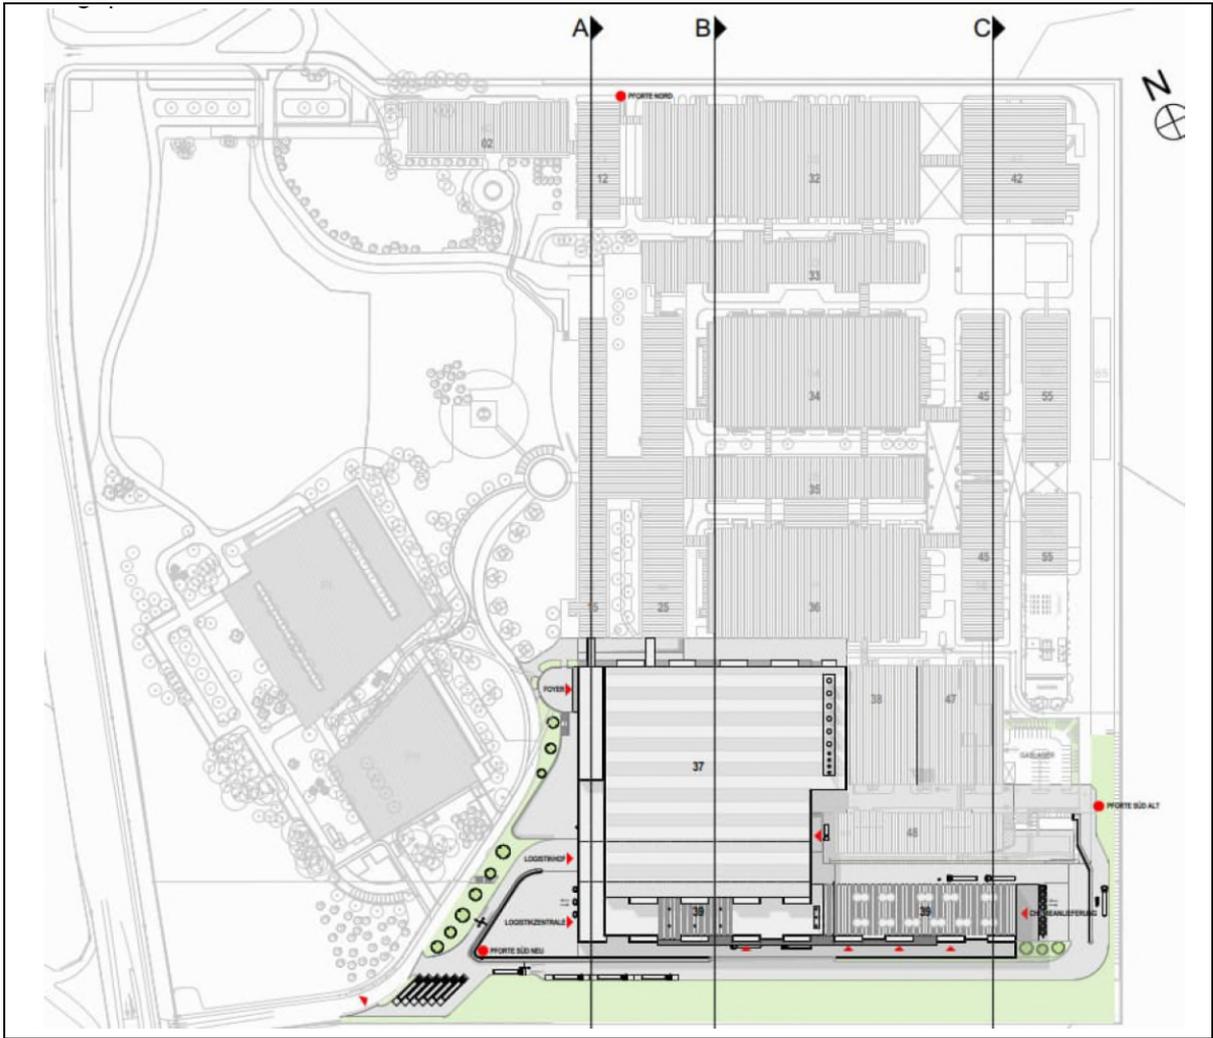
Lageplan mit Kennzeichnung der neuen Gebäude
